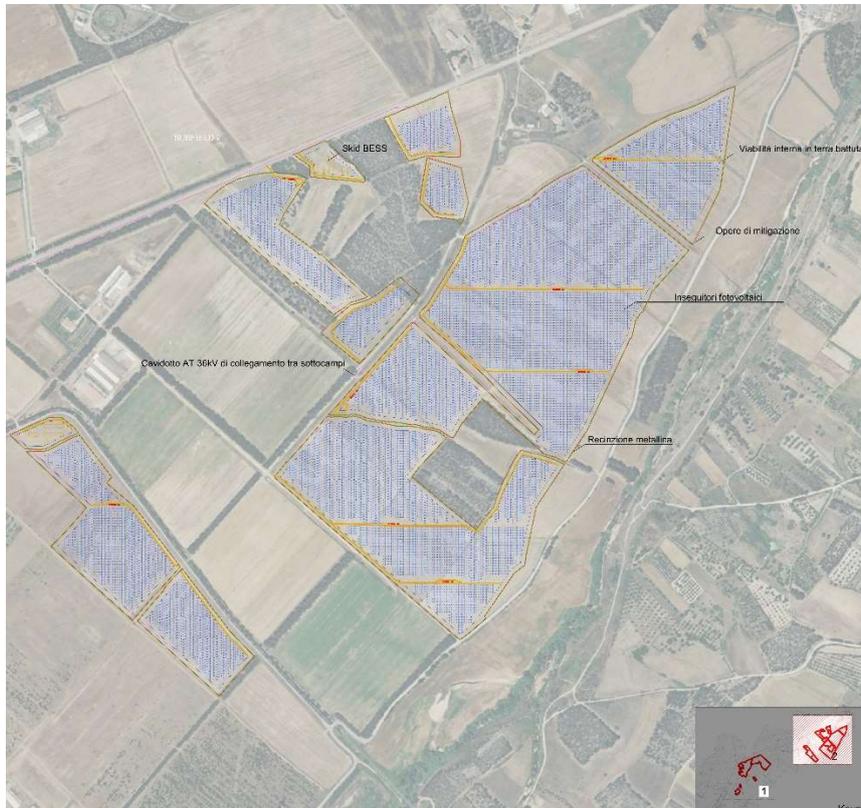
Layout di impianto Area EST - (rif: ICA_103_Tav09_Layout impianto su ortofoto)
